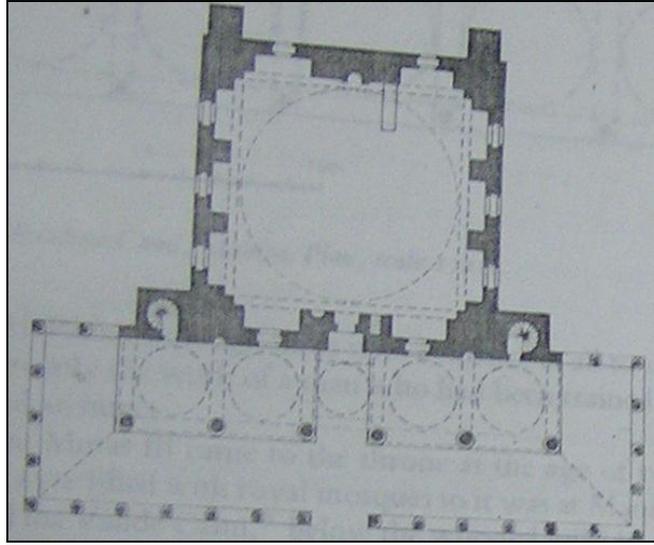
المسقط الأفقي لمسجد إبراهيم باشا الخادم - استانبول
